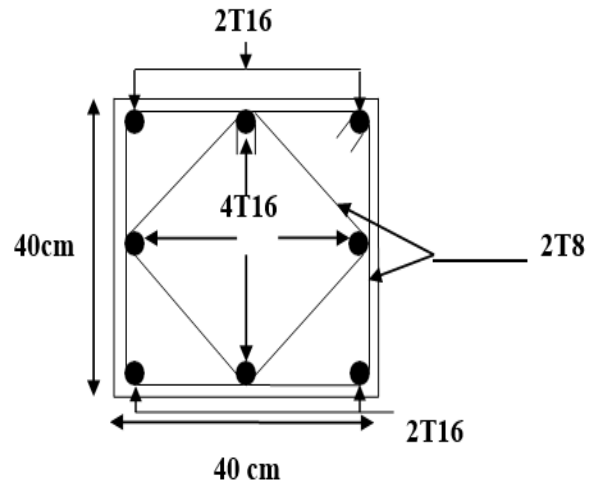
Ferraillage des poteaux de 6, et 7 étage
